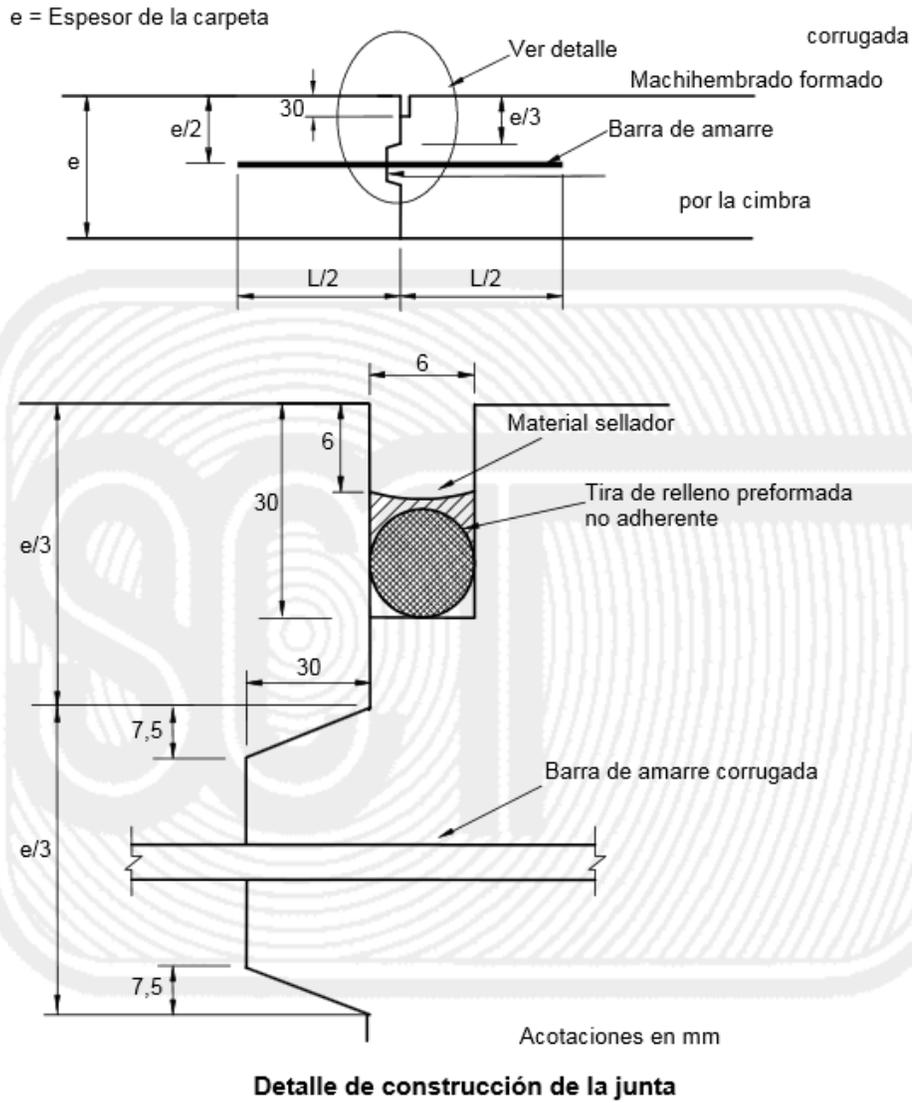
Corte y sellado de juntas longitudinales de construcción (Tipo B) con barras de amarre
